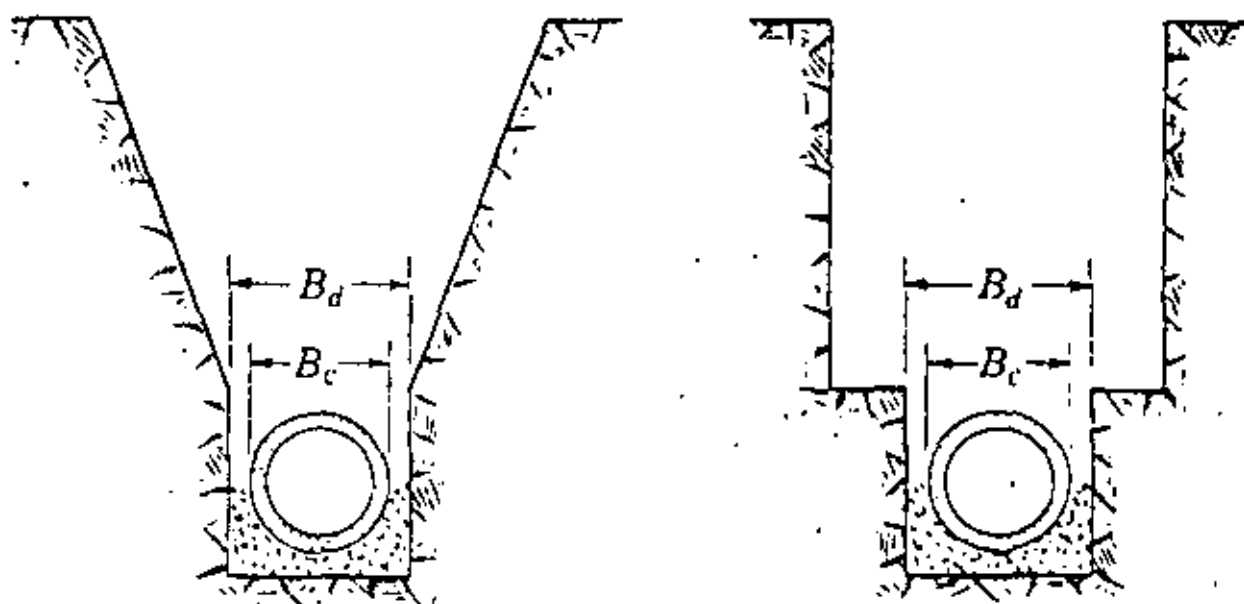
EJEMPLOS DE SUB-ZANJAS
